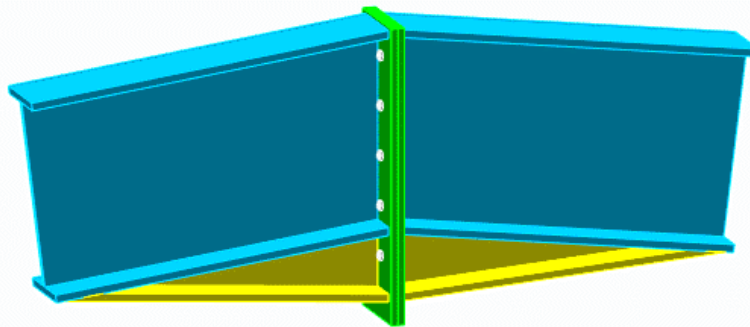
Vue 3D de l'assemblage au niveau de faitage
